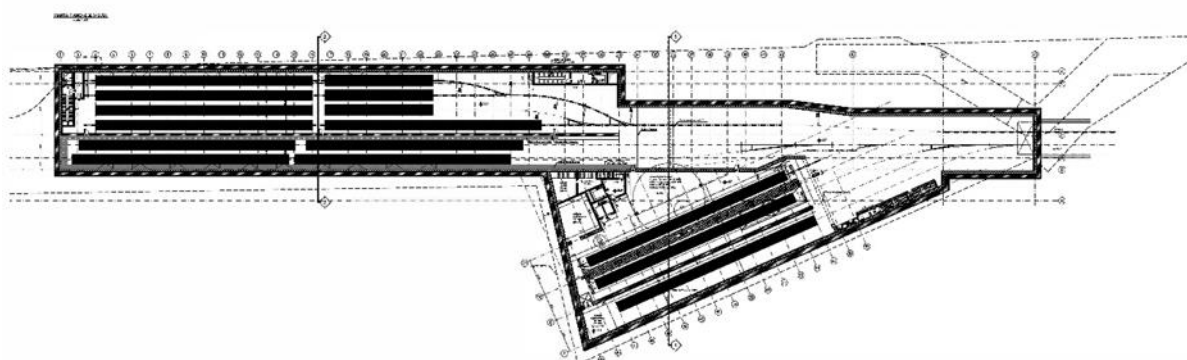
Deposito/officina Rebaudengo: Pianta Piano - 2
